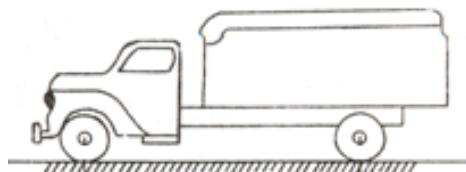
Acción Abrasiva de Llantas Fuente: AASTHO
